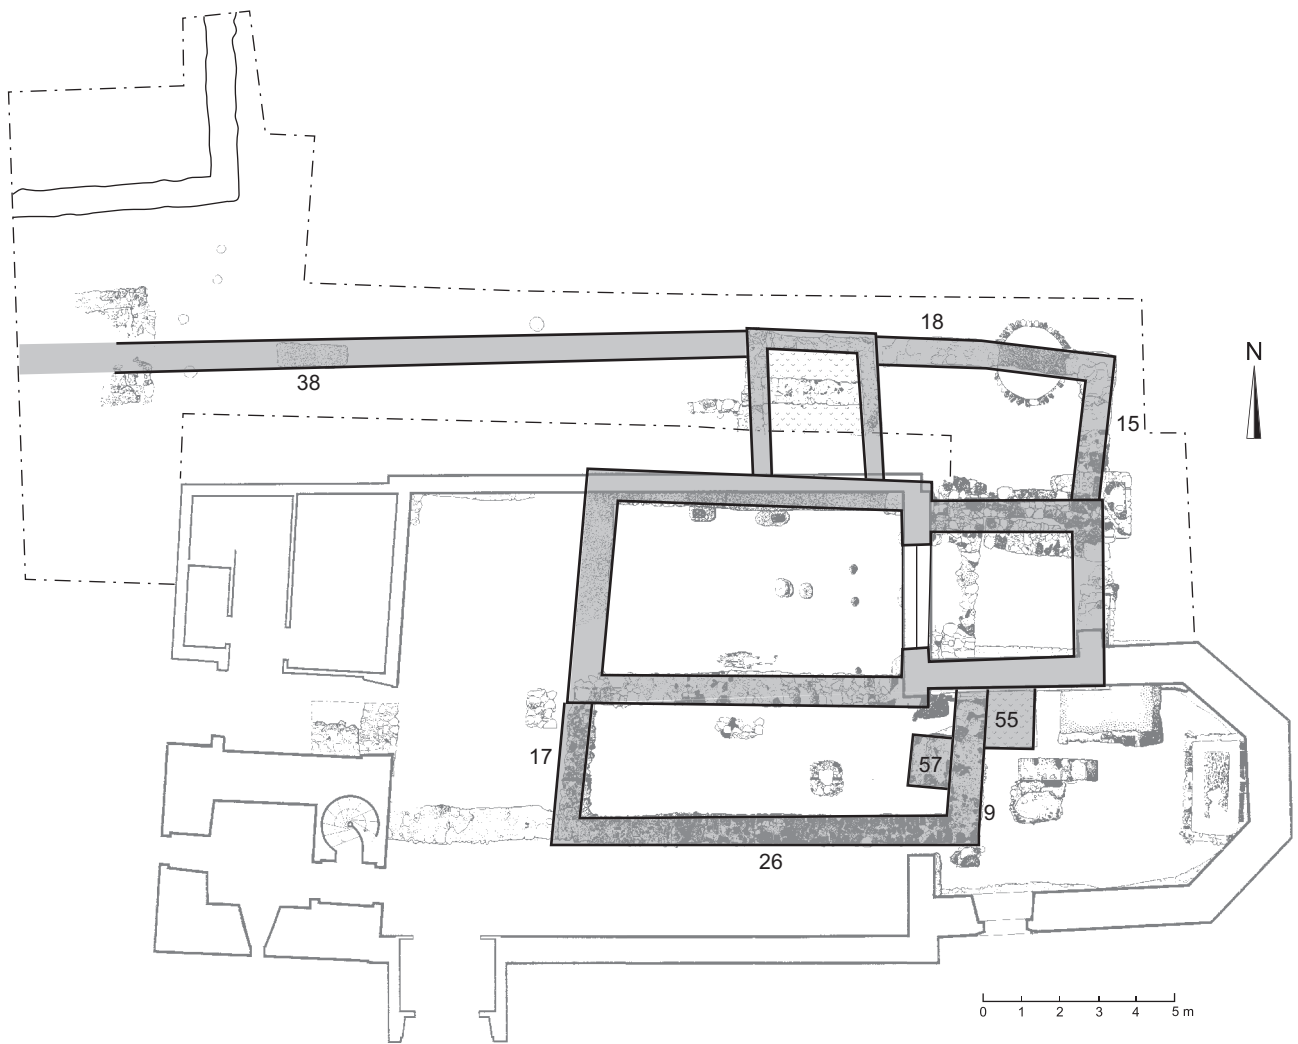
Winterthur-Veltheim. Grundriss der Kirche mit Südkapelle und Friedhofmuer im Norden. M. 1:200.
